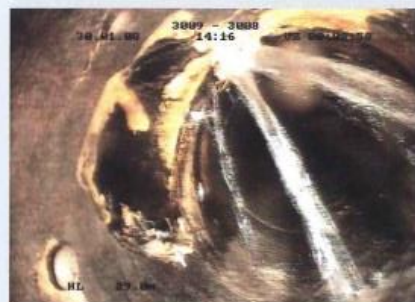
Nicht fachgerecht angeschlossener Zulauf mit großem Ausbruch
